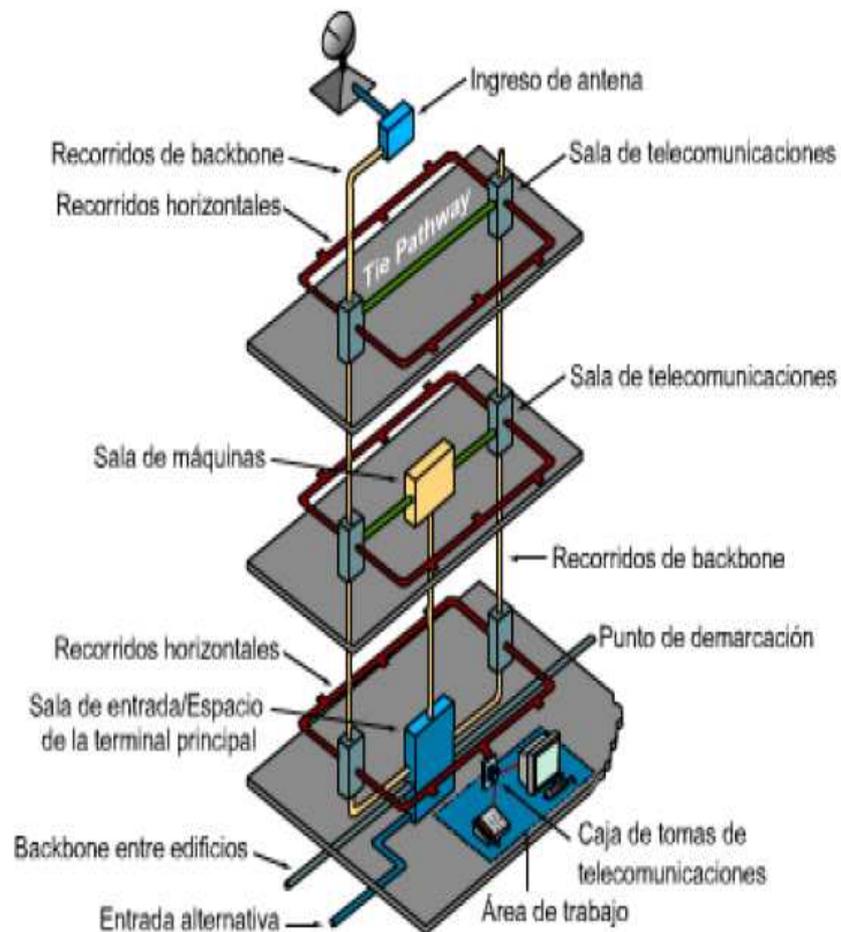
Subsistemas de cableado estructurado<sup>3</sup>
